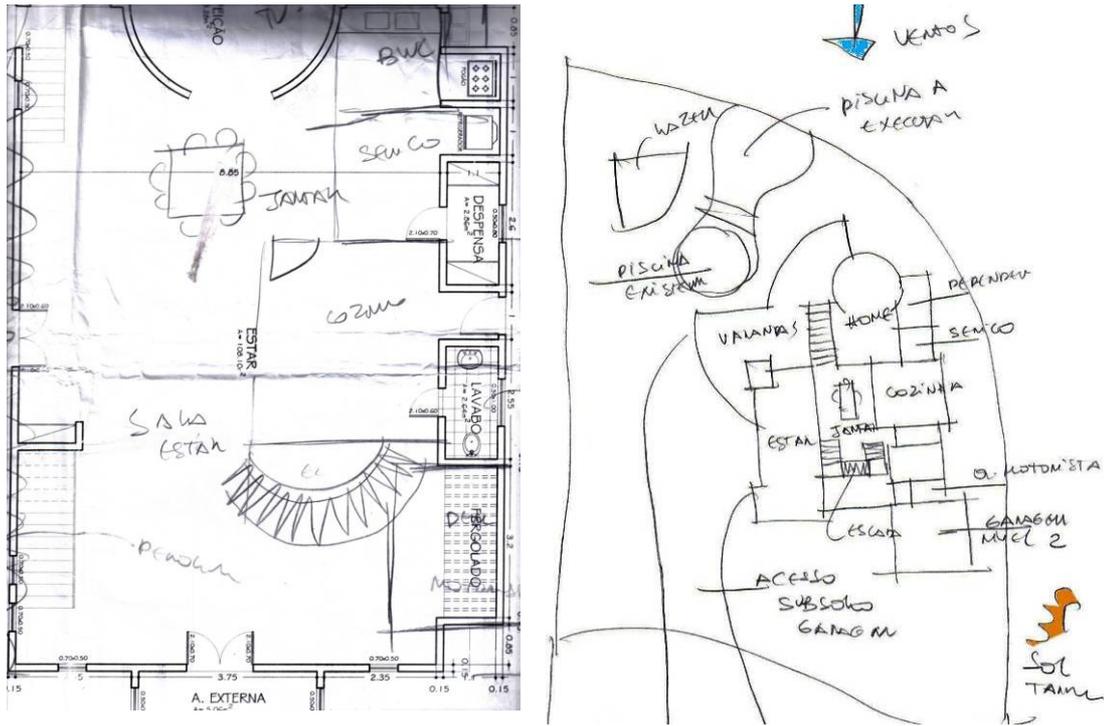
Planta baixa do pavimento térreo (pré e pós-reforma)
